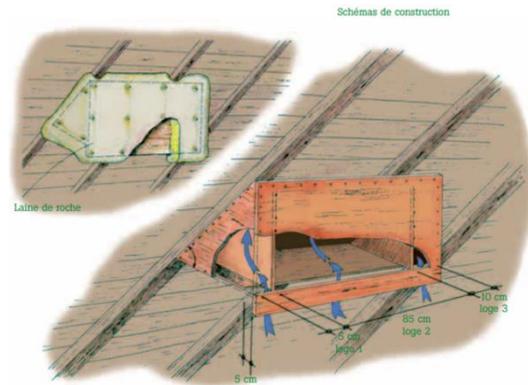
Schéma de gîte isolé sur la toiture © Fairon, 2003
